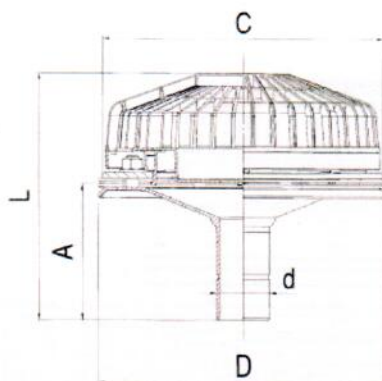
Wpust dachowy do dachów z pokryciem z tworzyw sztucznych (wymiary wpustu dachowego wg rys. B6)
